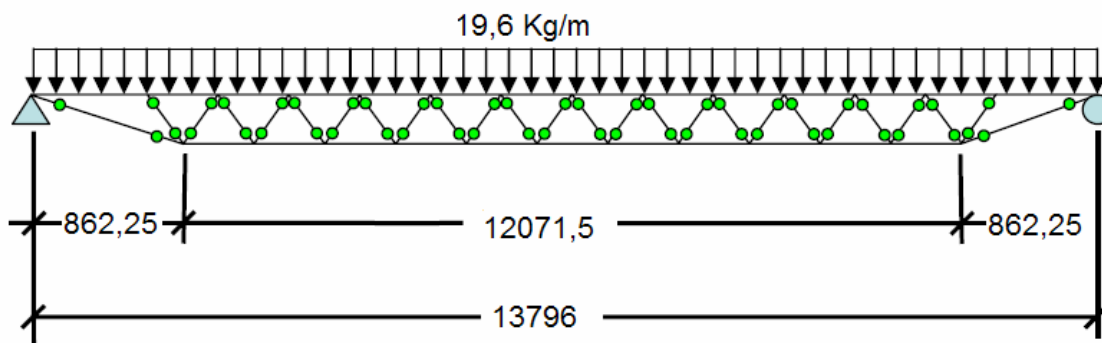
Modelo tradicional de vigas treliçadas (joists)- 30k8 [59]
